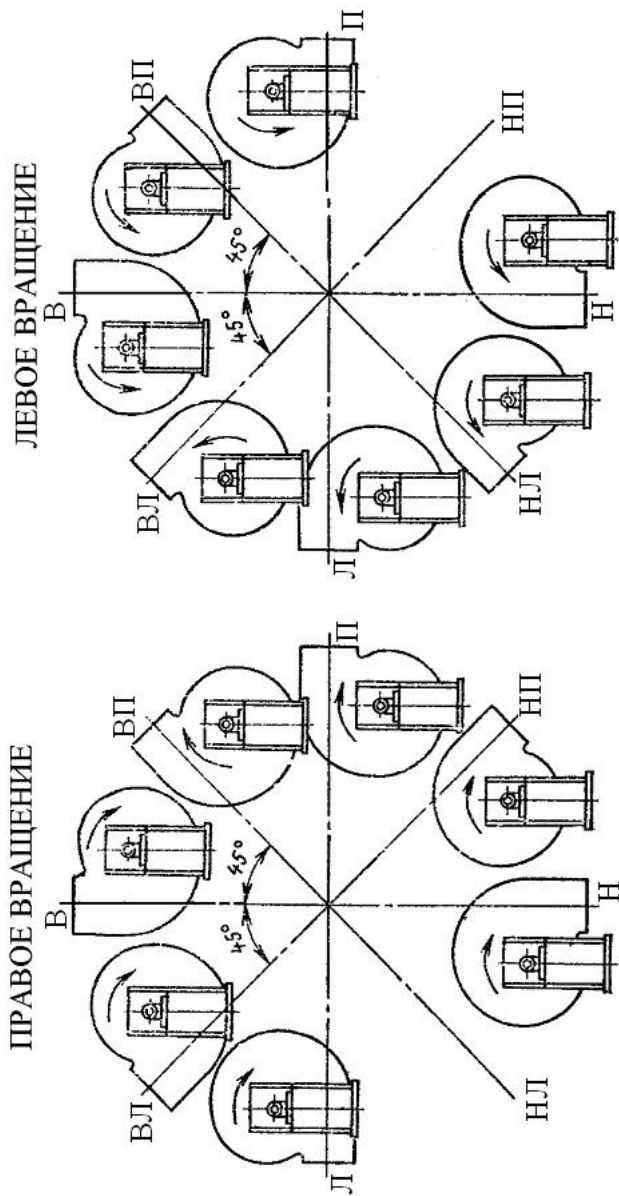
Стандартные положения корпусов вентиляторов общепромышленного назначения
